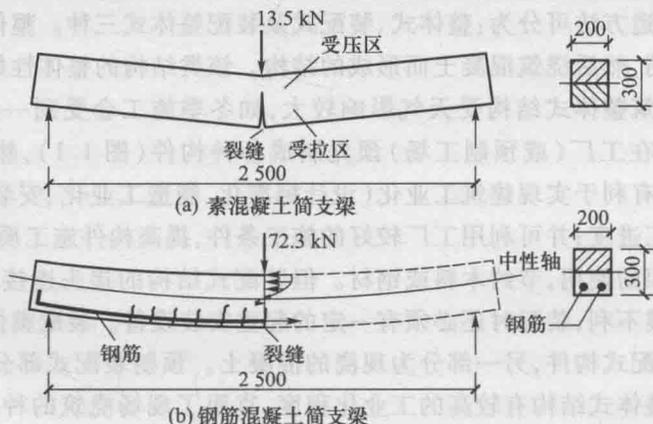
素混凝土和钢筋混凝土简支梁的承载力和破坏形态
